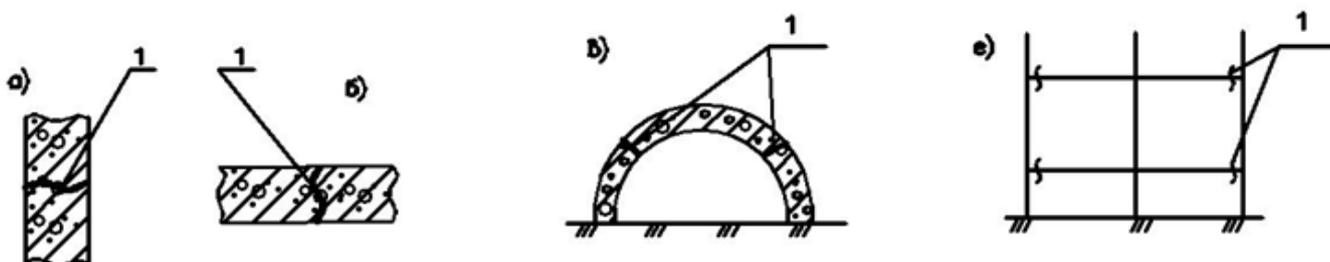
Схемы расположения рабочих швов в железобетонных конструкциях:
